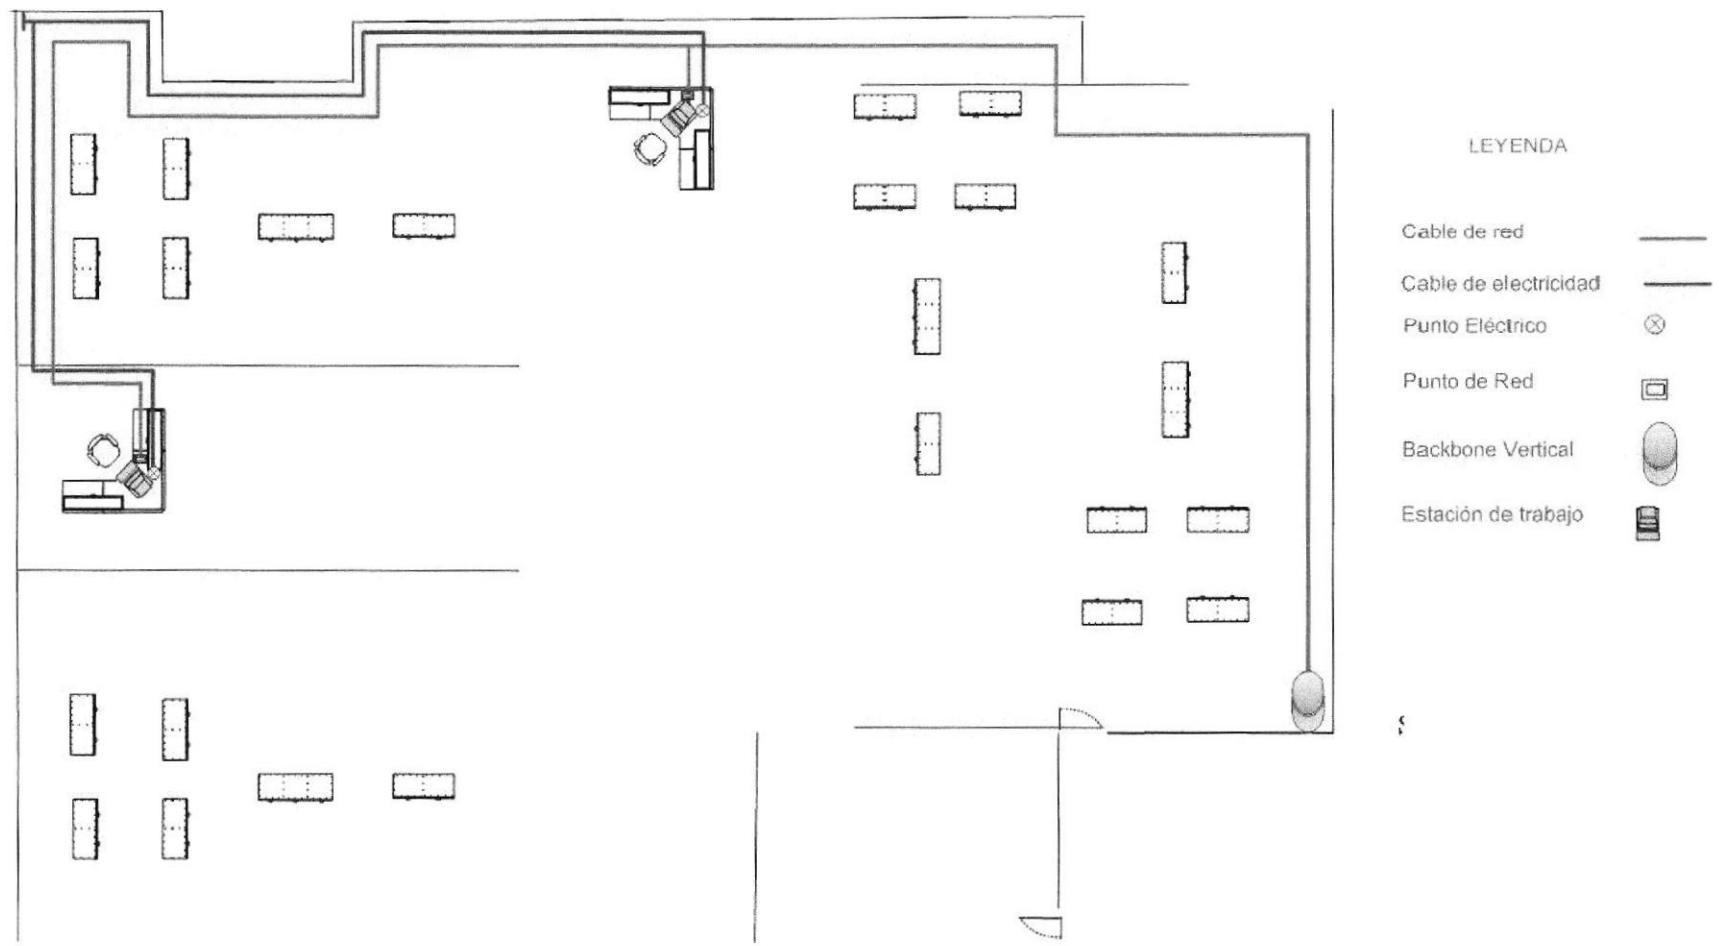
PRIMER PISO EDIFICIO SUCURSAL SUR
